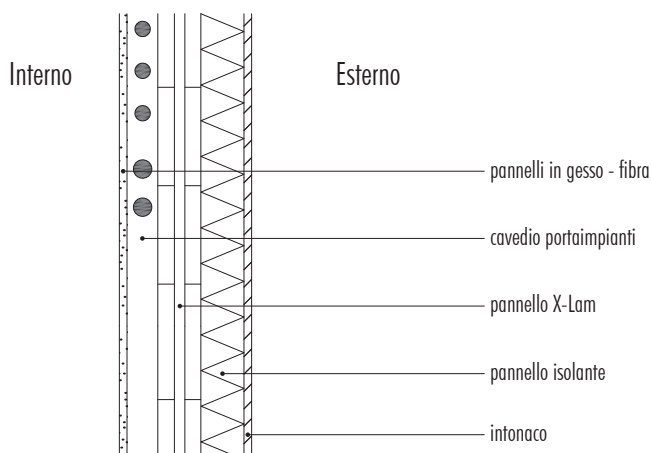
\_Schema di parete in X-Lam + cappotto esterno e cavedio impianti
